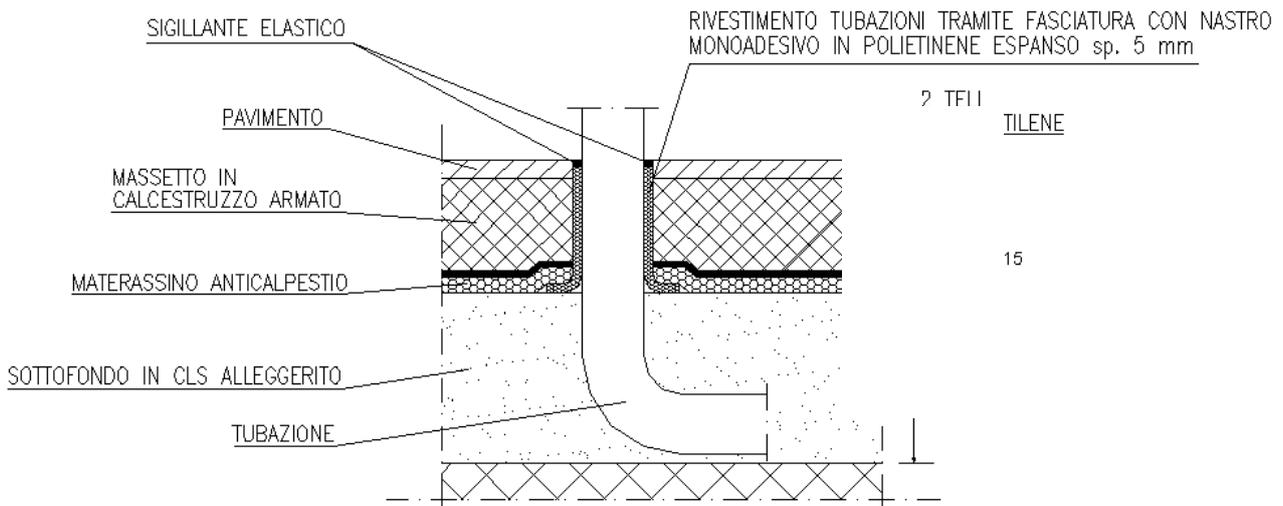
ipotesi di desolidarizzazione tra massetto e tubazione.
